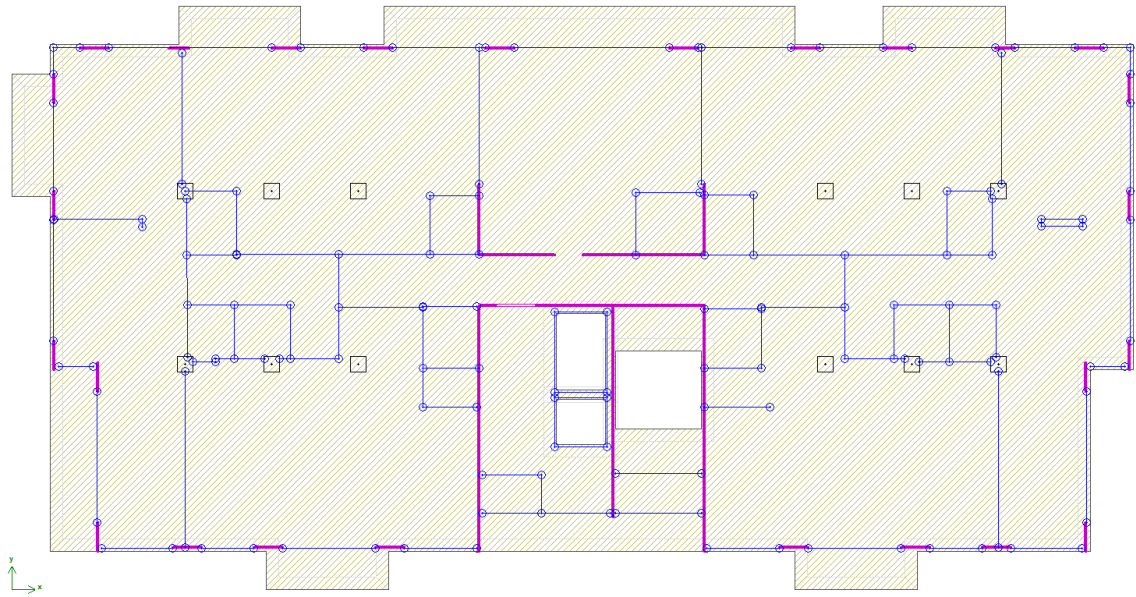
Расчетная модель перекрытия для выполнения раздела
